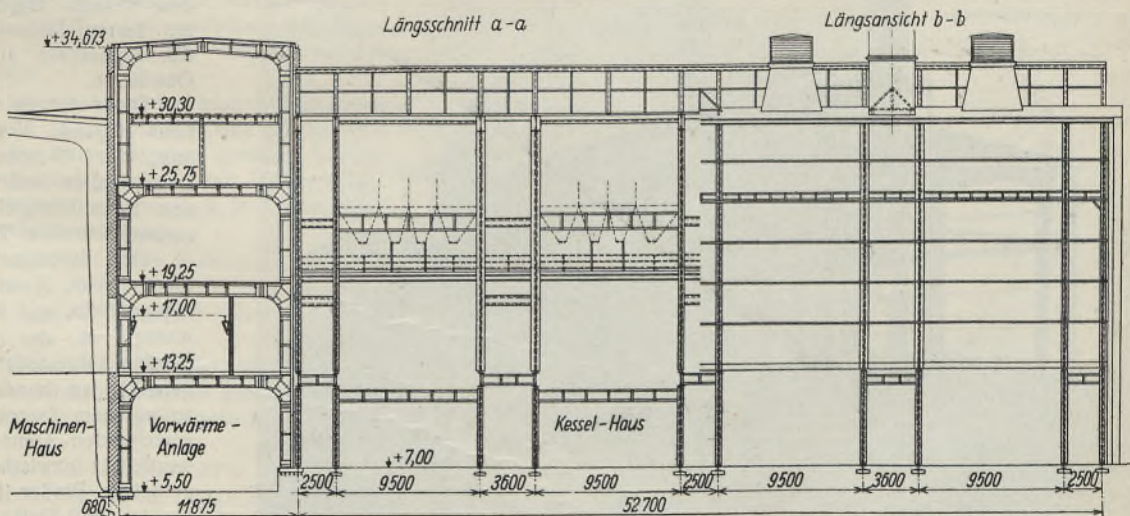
Längenschnitt durch das Kesselhaus und Vorwärmanlage.
